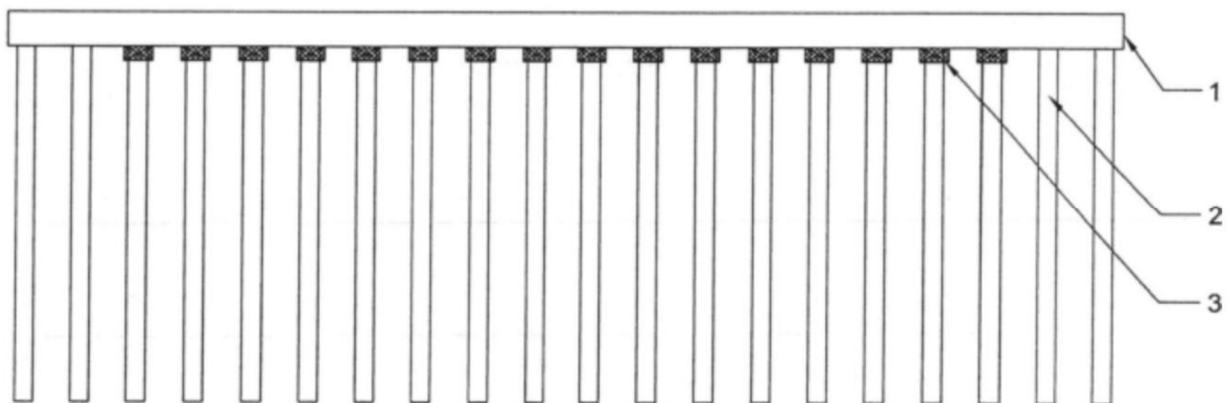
Спосіб спорудження пальово-плитного фундаменту висотної будівлі, запропонований О.А. Шулятьєвим і І.А. Бойко: 1 - фундаментна плита; 2 - паля; 3 – домкрат
